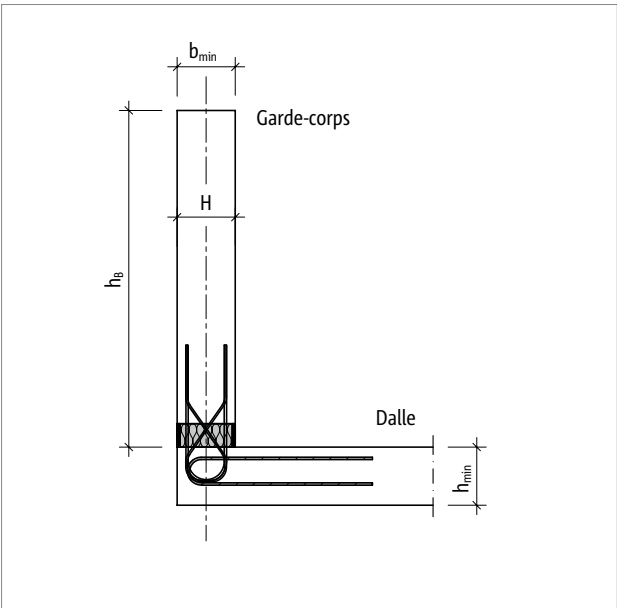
Schöck Isokorb® T type A : système statique ; Hauteur du garde-corps h_B ; Isokorb® hauteur H
